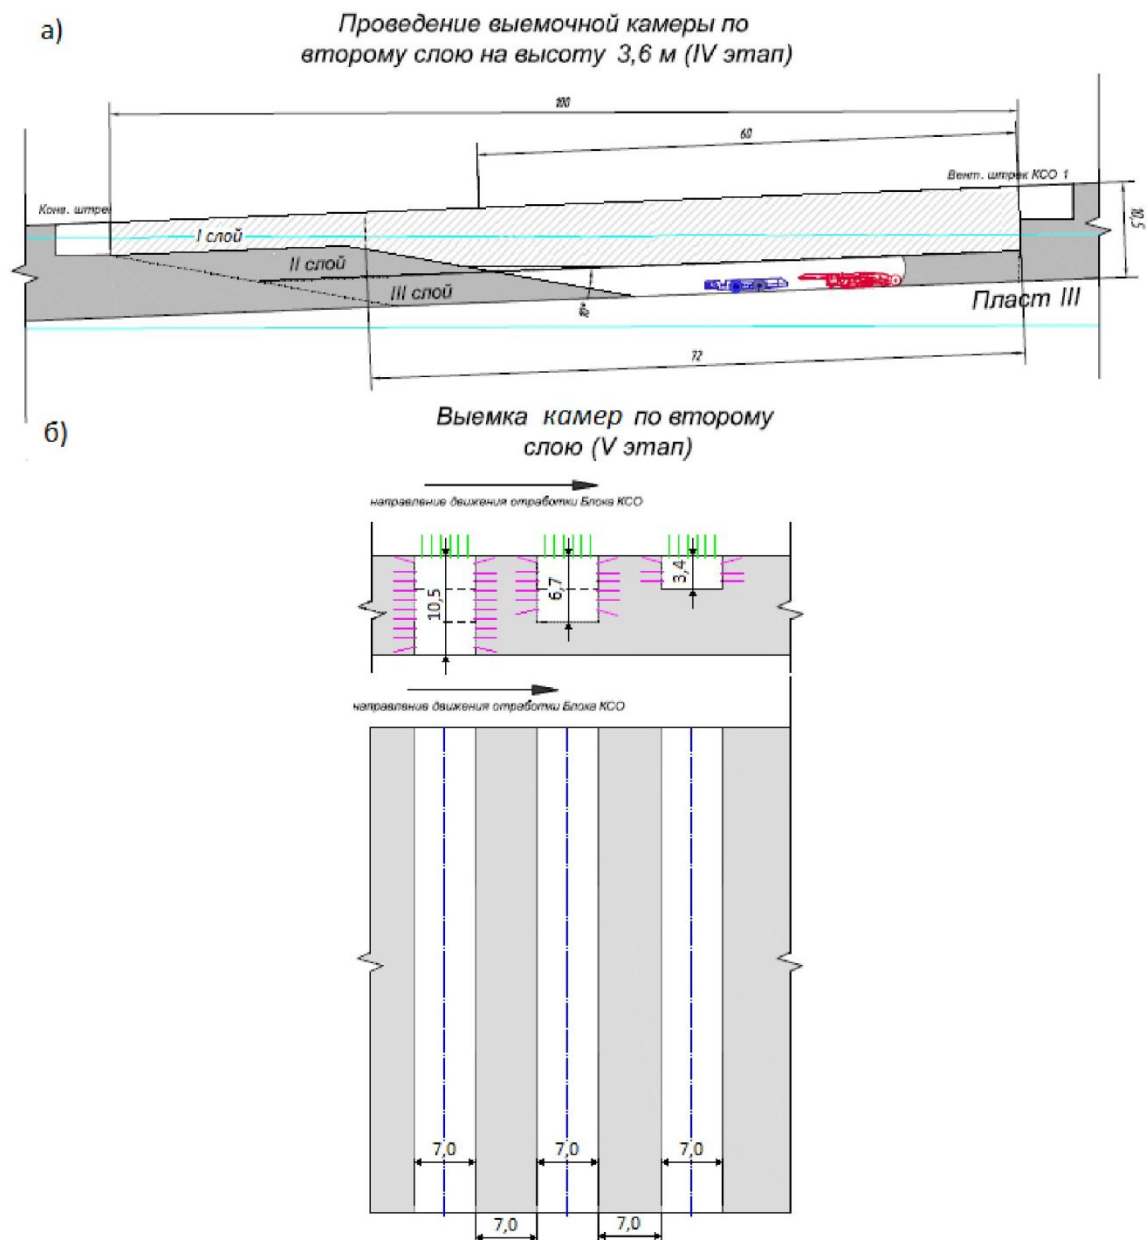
Схема отработки пласта III камерной системой разработки, выемочные блоки КСО 1-1 и КСО 1-2, шахта ЗАО «Распадская-Коксовая»: а-вертикальное сечение по оси камер; б- поперечные разрезы и план камер
